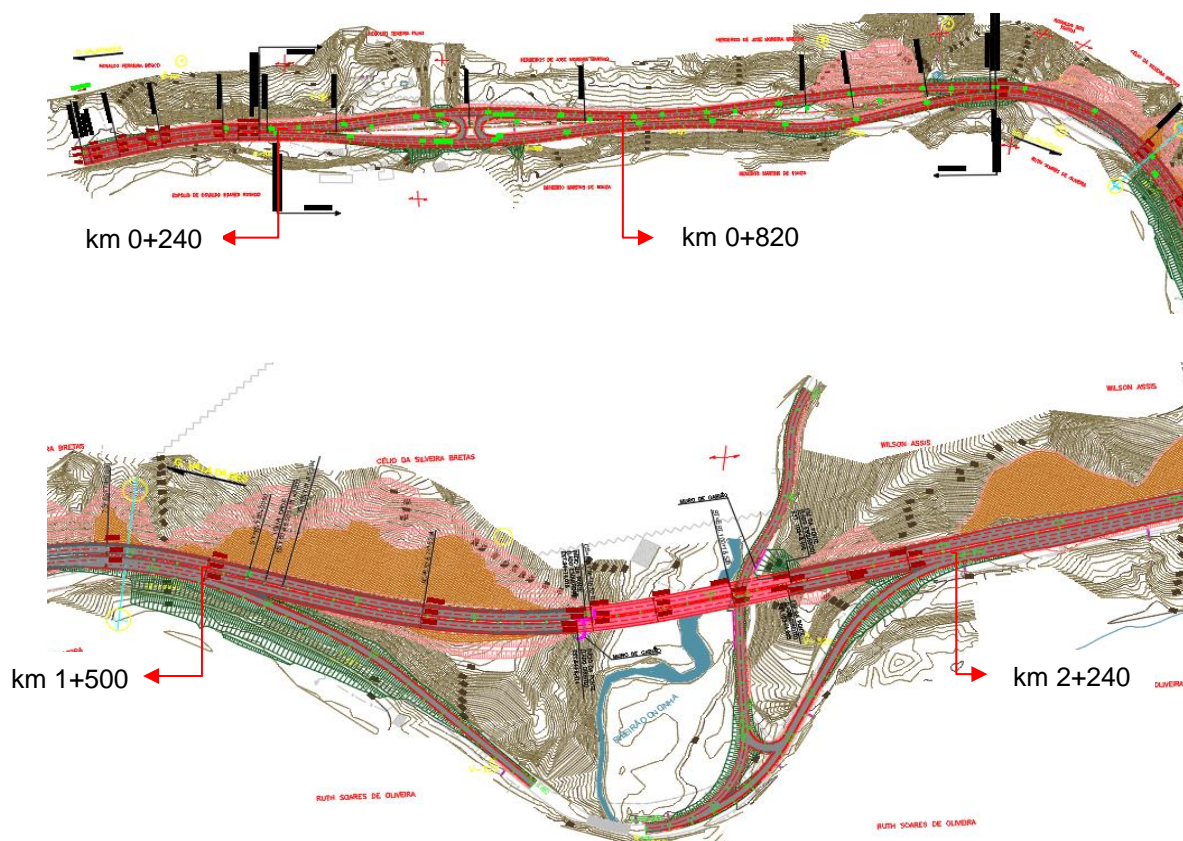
Extrato da planta do Troço I (SENER-ENGIVIA, 2018)
